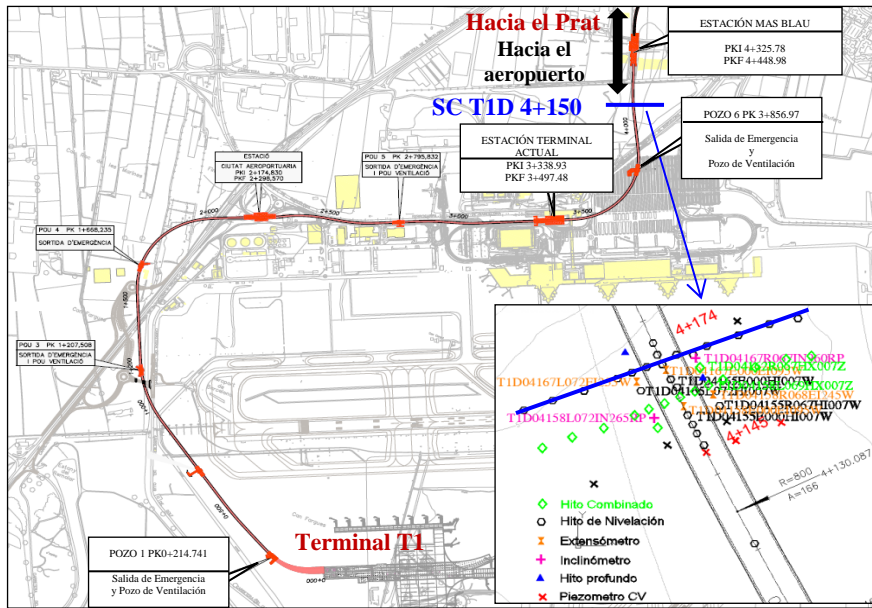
11. Posición en planta de la instrumentación y de la sección de control T1D PK 4+150 en el trazado de la Línea 9
